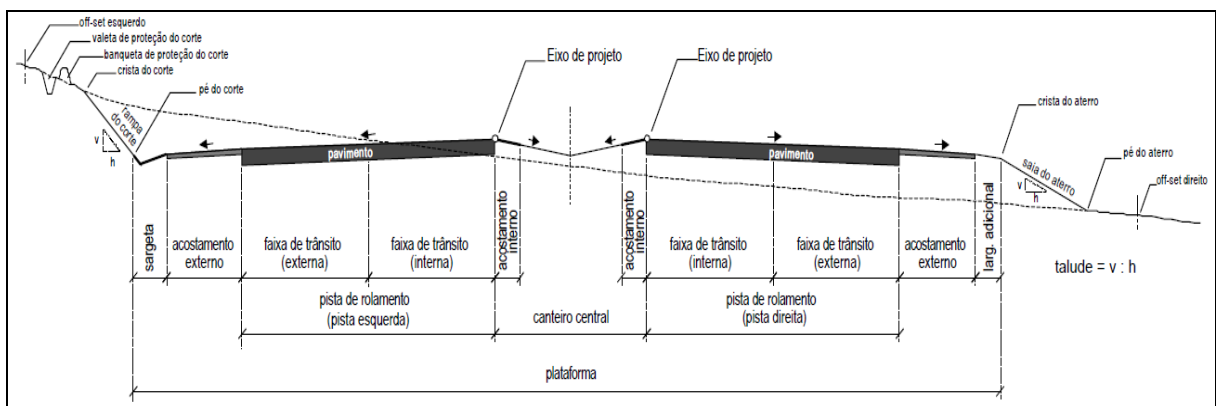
Elementos de seção transversal: rodovias em pista dupla
